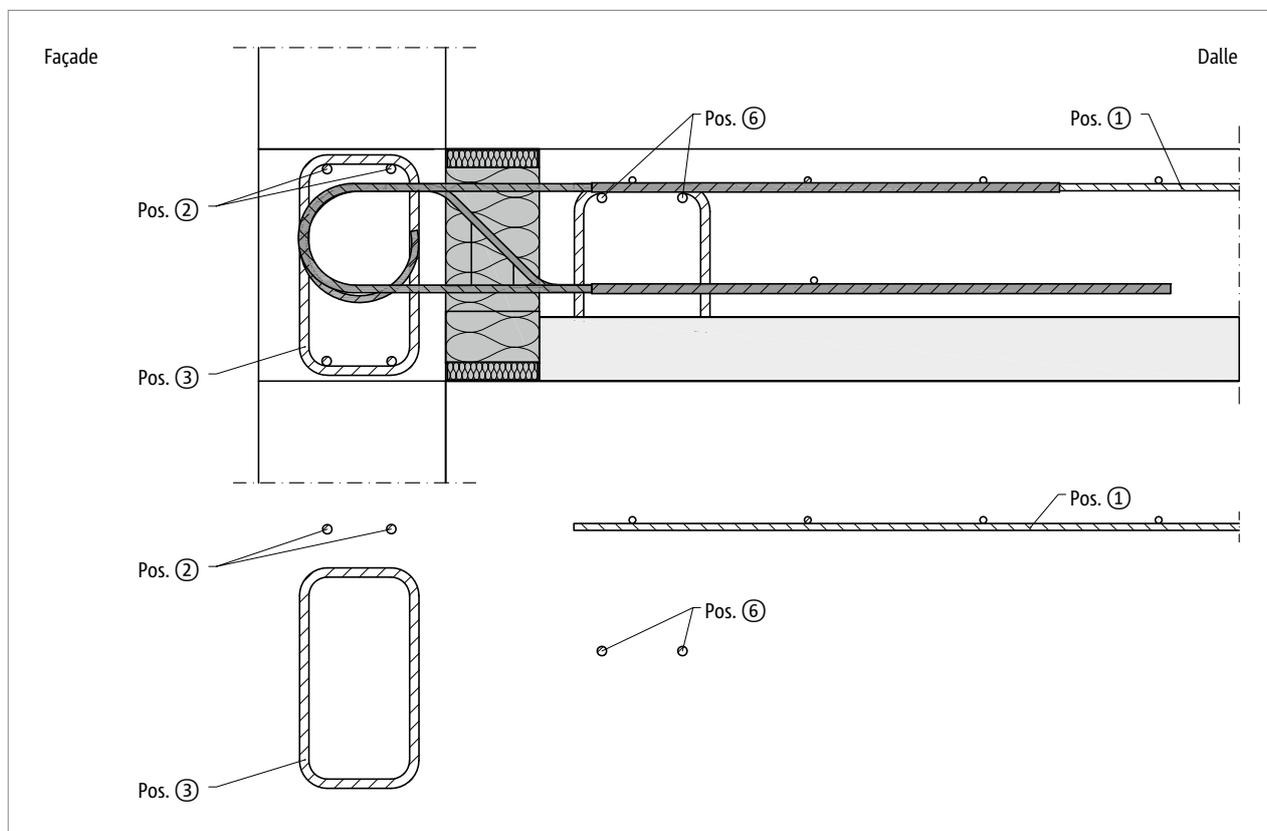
Schöck Rutherma® T type DF : armatures à prévoir par le client en association avec des planchers avec prédalles suspendues
